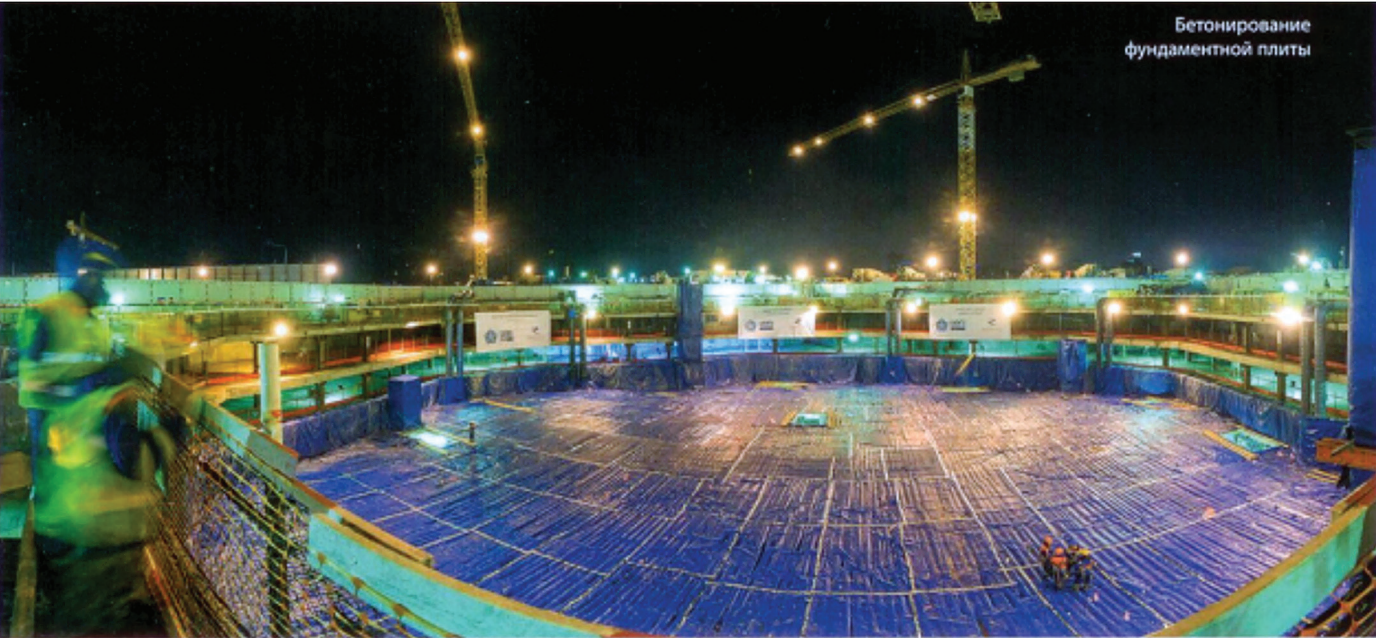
Бетонирование фундаментной плиты коробчатого фундамента
